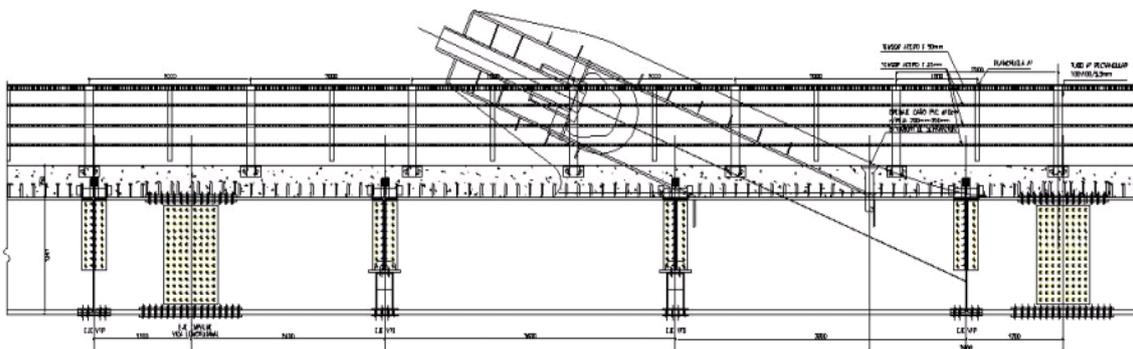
Viga longitudinal, barandales, losa del tablero y porta obenque
